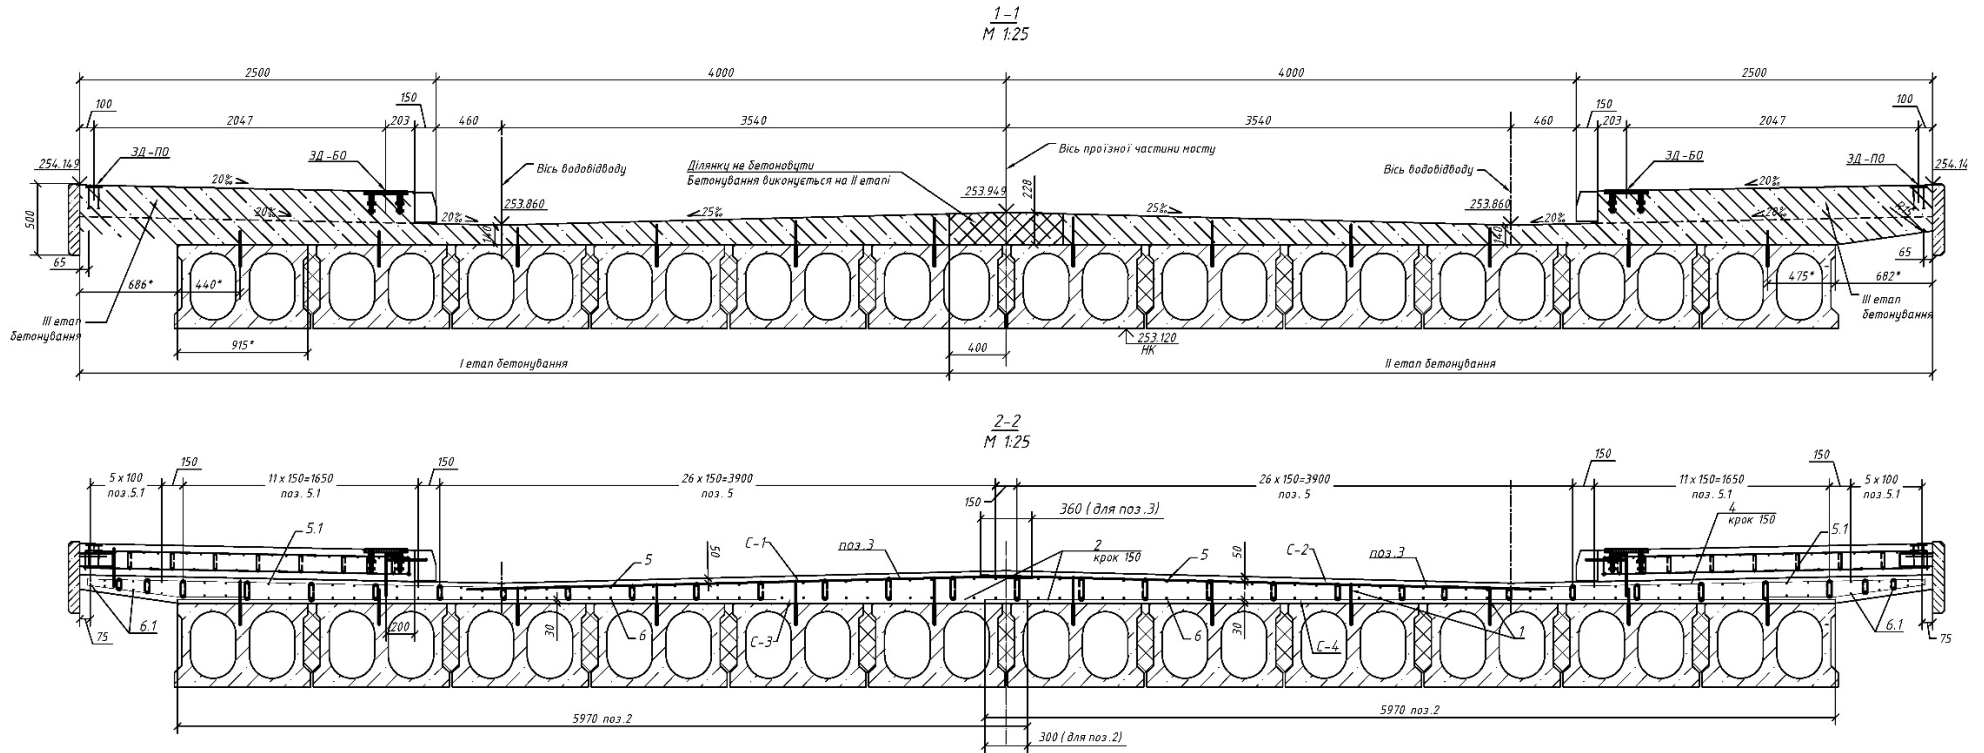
Перерізи 1-1 опалубне креслення та 2-2 арматурне креслення.
